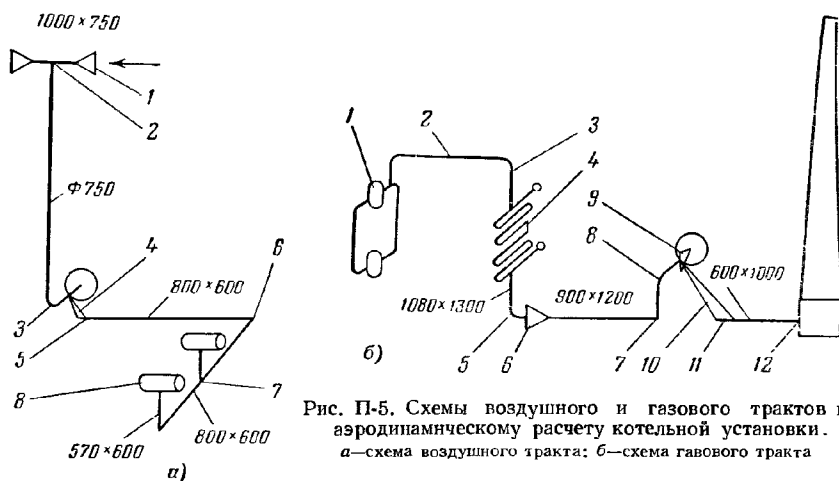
Схемы воздушного и газового трактов к аэродинамическому расчету котельной установки.
